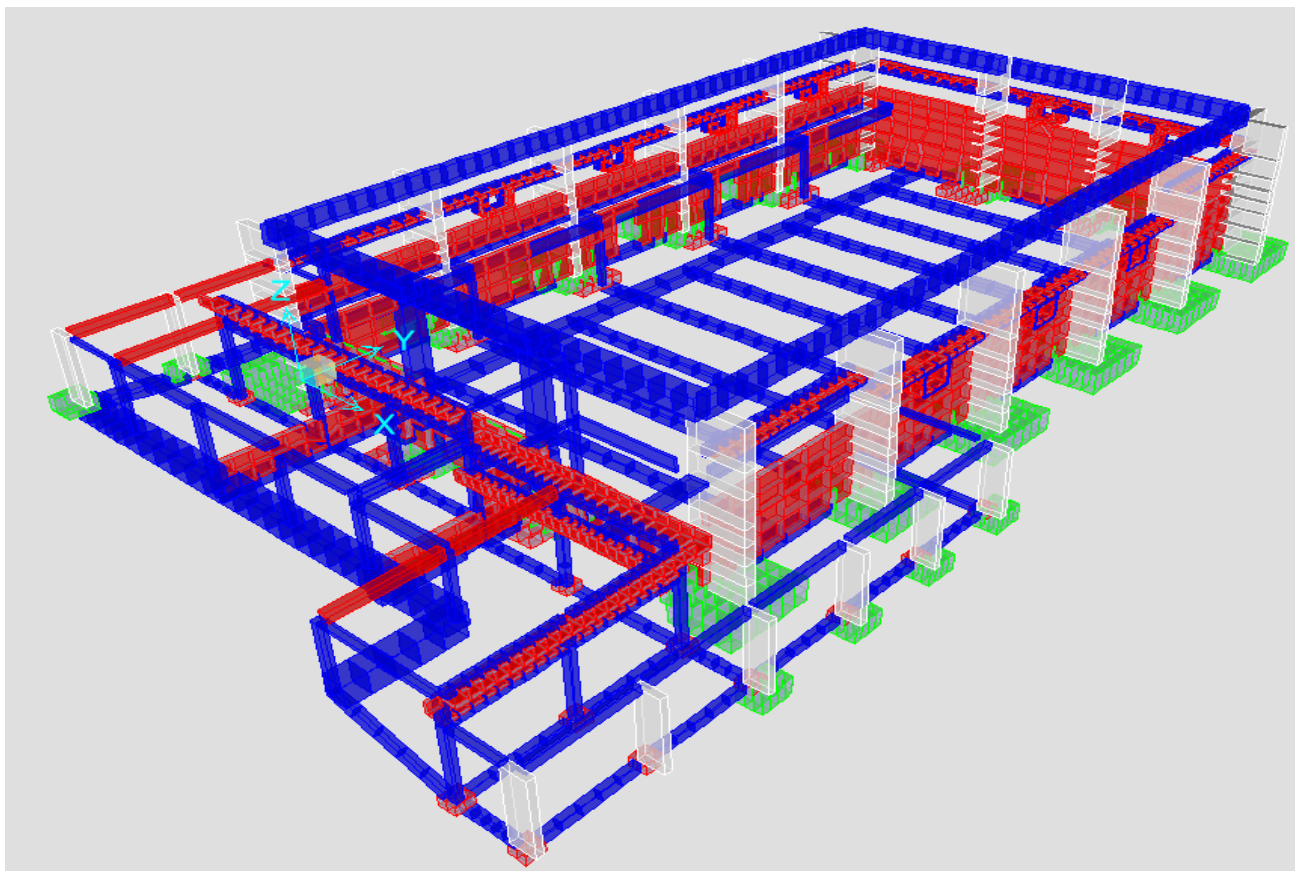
Modellazione strutturale stato di progetto (modello con tamponamenti in c.a.)
